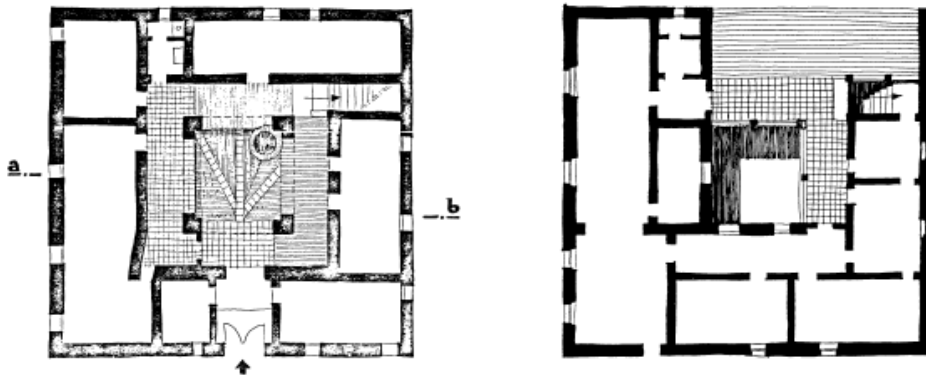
Plan du rez-de-chaussée et de l'étage du bâtiment 'A' de la Casbah de Bejaia
